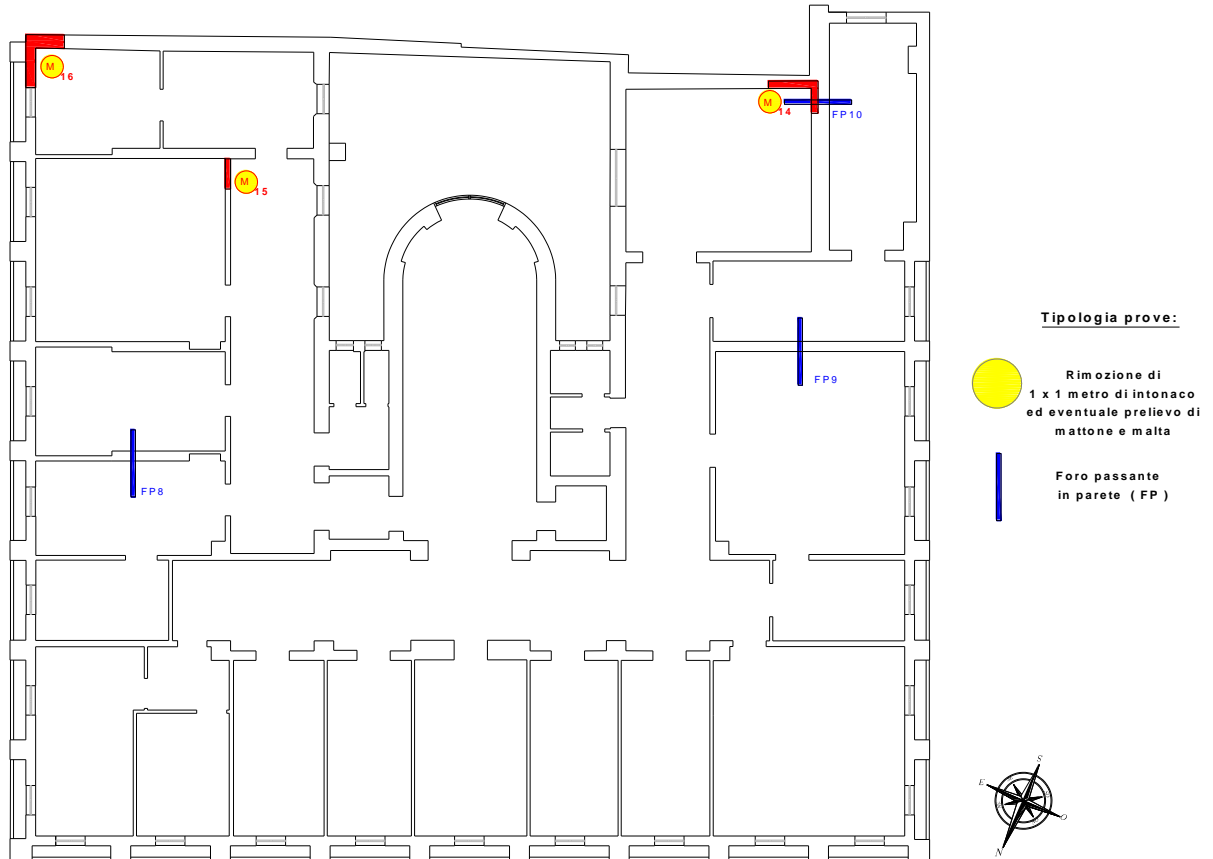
Pianta chiave con indicazione dei punti di sondaggio ai piani terra e primo.
